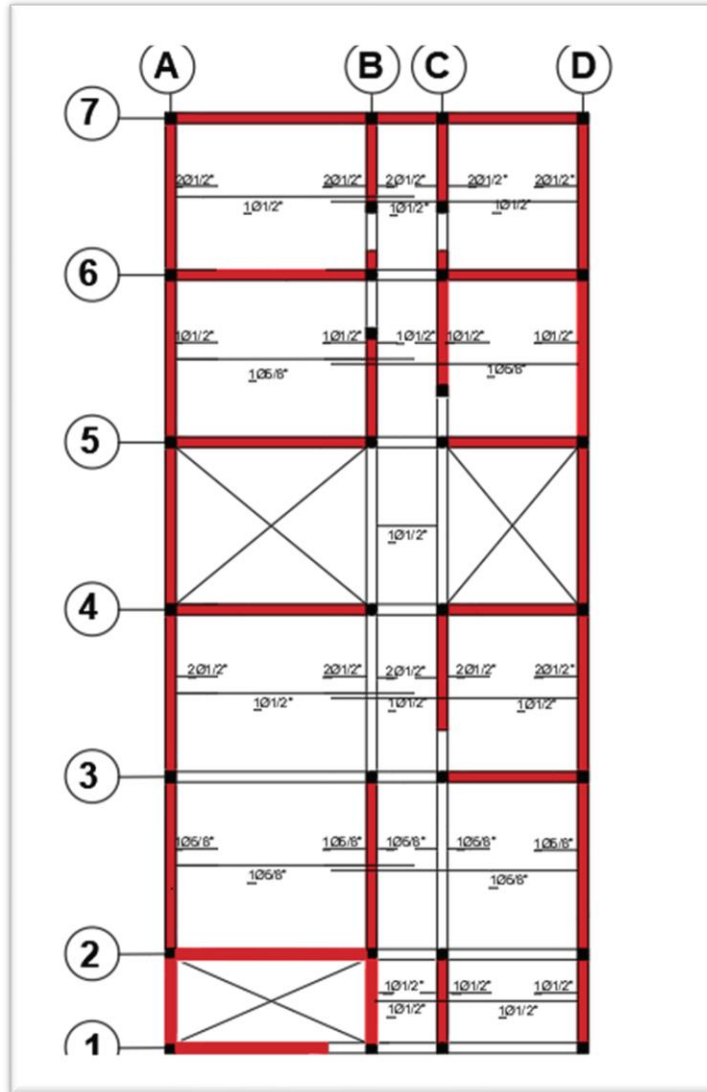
Distribución del acero en las viguetas de la losa aligerada
